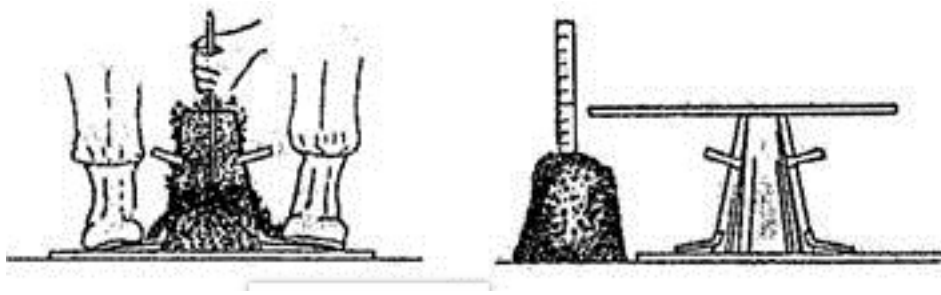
Ensavo de Slump Fuente: CIVILGEEKS
